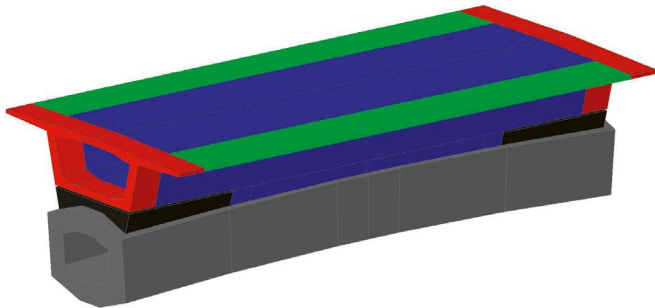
Croquis de las fases de hormigonado del cierre del tablero.
